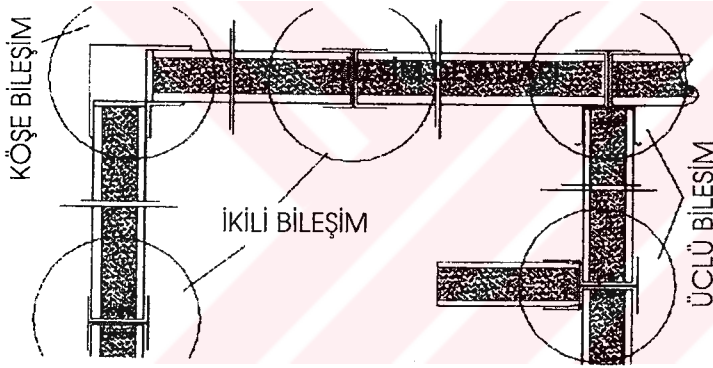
Prefabrike Yapı – Duvar Panelleri
